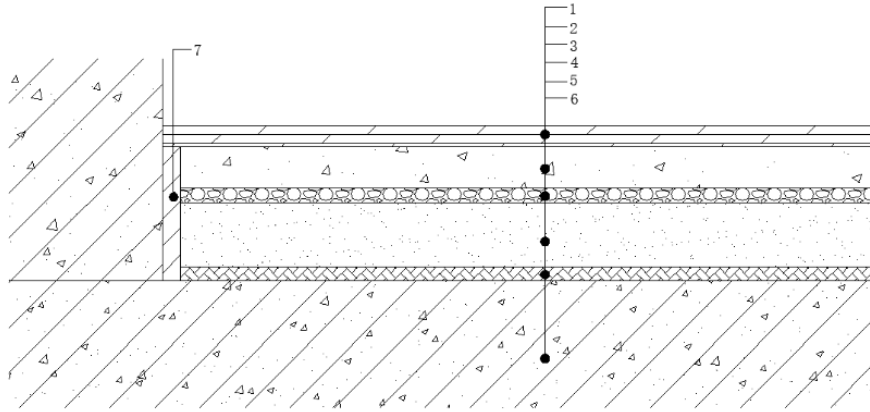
高抗裂混凝土保温隔声系统构造三
